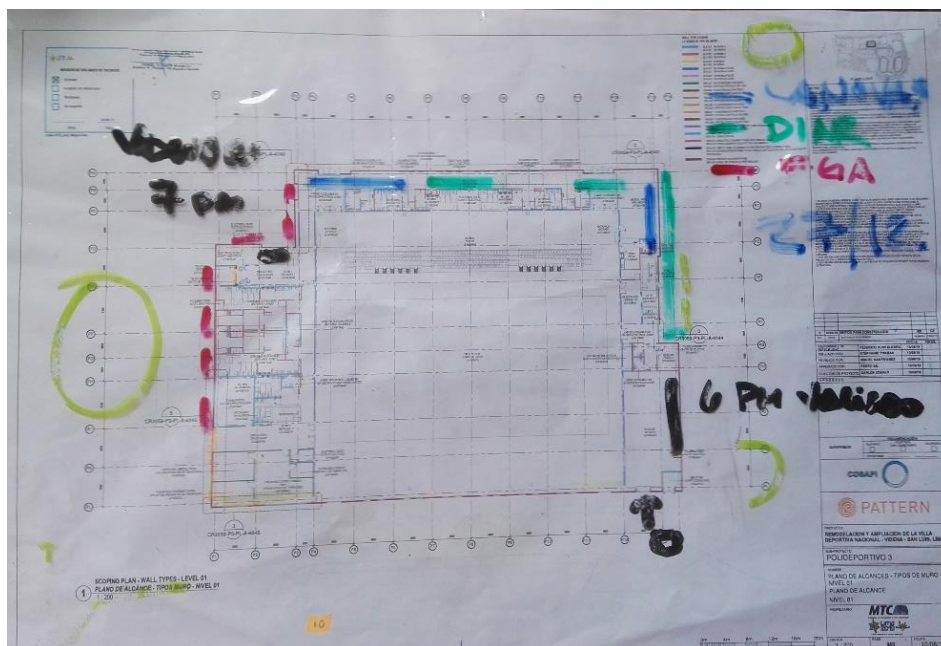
Plan diario de los trabajos de fachada. Fuente: Elaboración propia.
